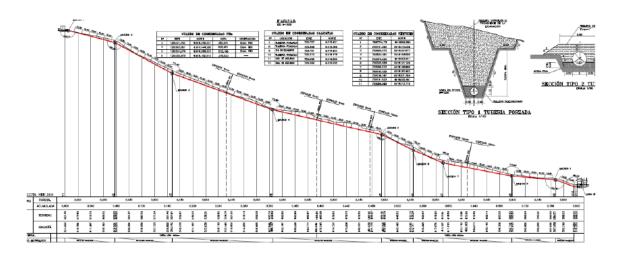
PERFIL LONGITUDINAL TUBERÍA FORZADA
